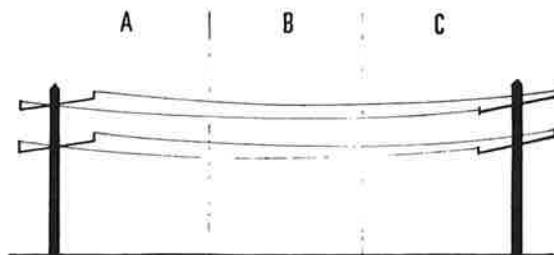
Découpage de l'espace séparant deux poteaux en trois intervalles égaux :
